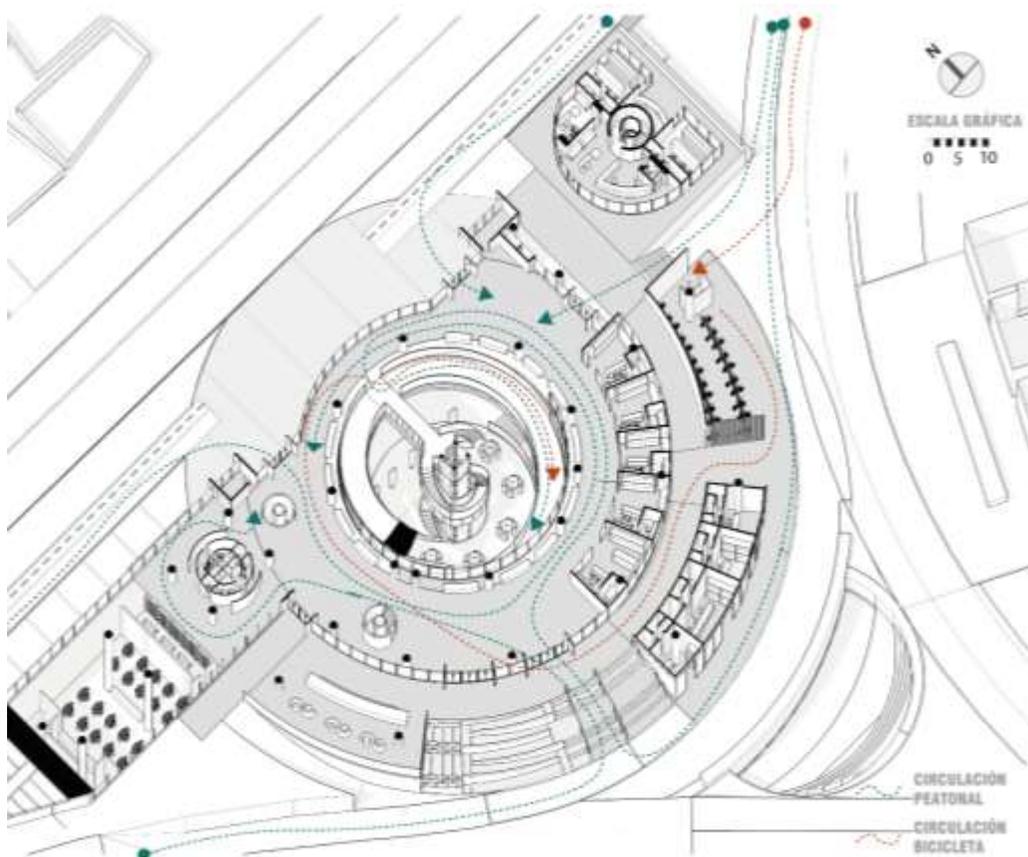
Planta de primer nivel. Elaboración propia (2020)
